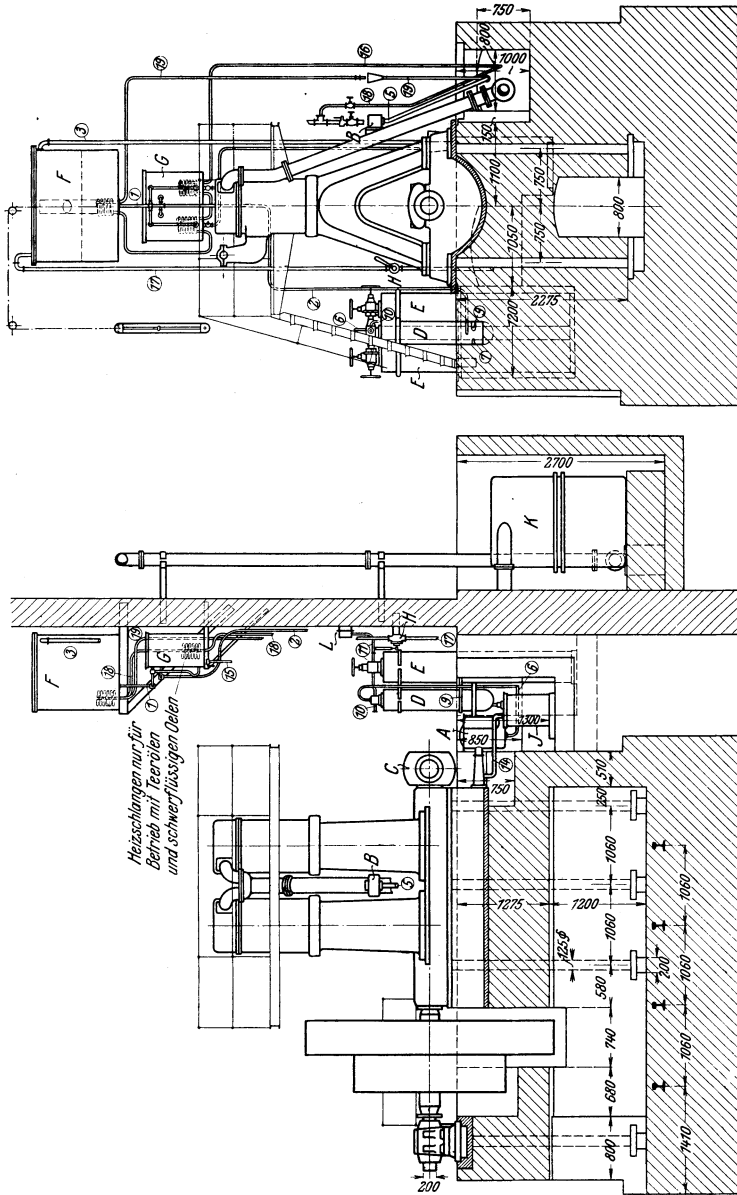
b—d. Rohrpläne zum Dieselmotorkraftwerk Fig. 222.
